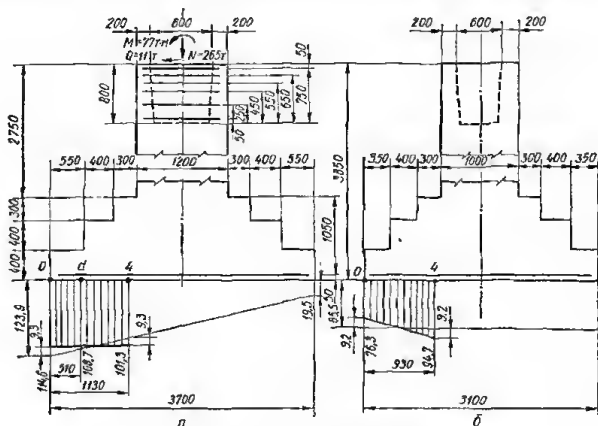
Расчетные схемы ступенчатого фундамента:
